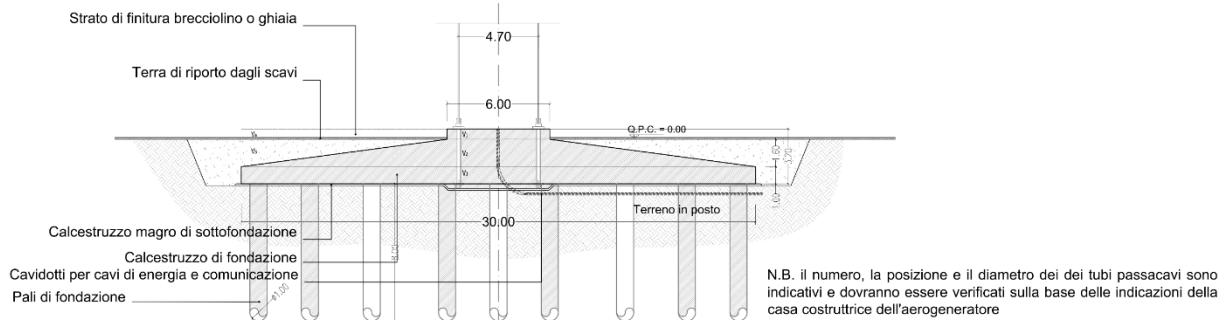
Pianta e vista della fondazione tipo dell'aerogeneratore
